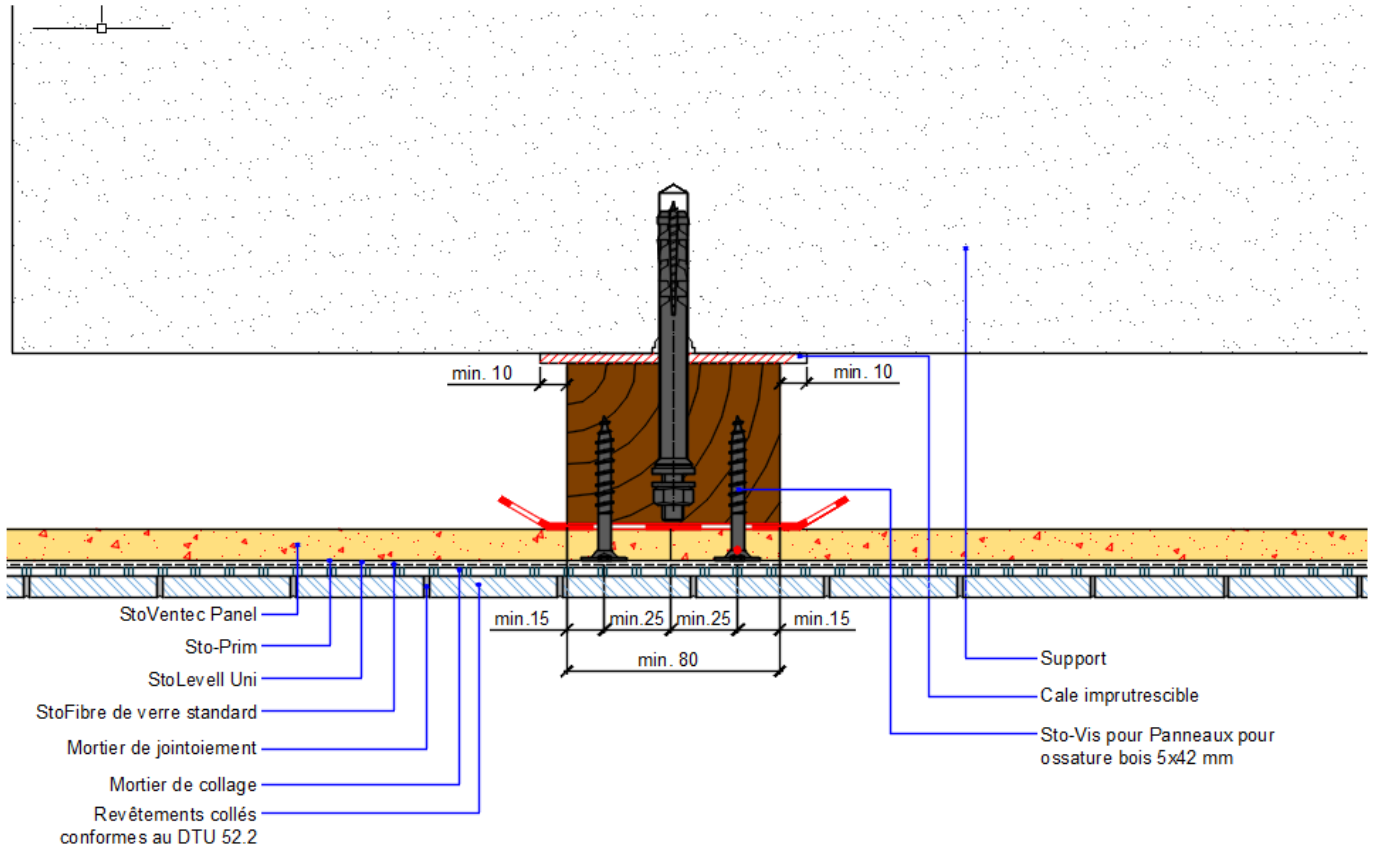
Fixation directe sur le support – Ossature bois – Détail cale de réglage
